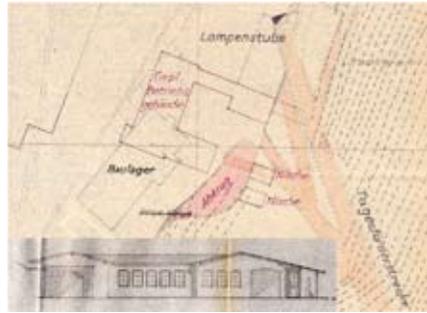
Abriss Baulager und Neubau des südlichen Werkseingangs. Bergarchiv Clausthal
